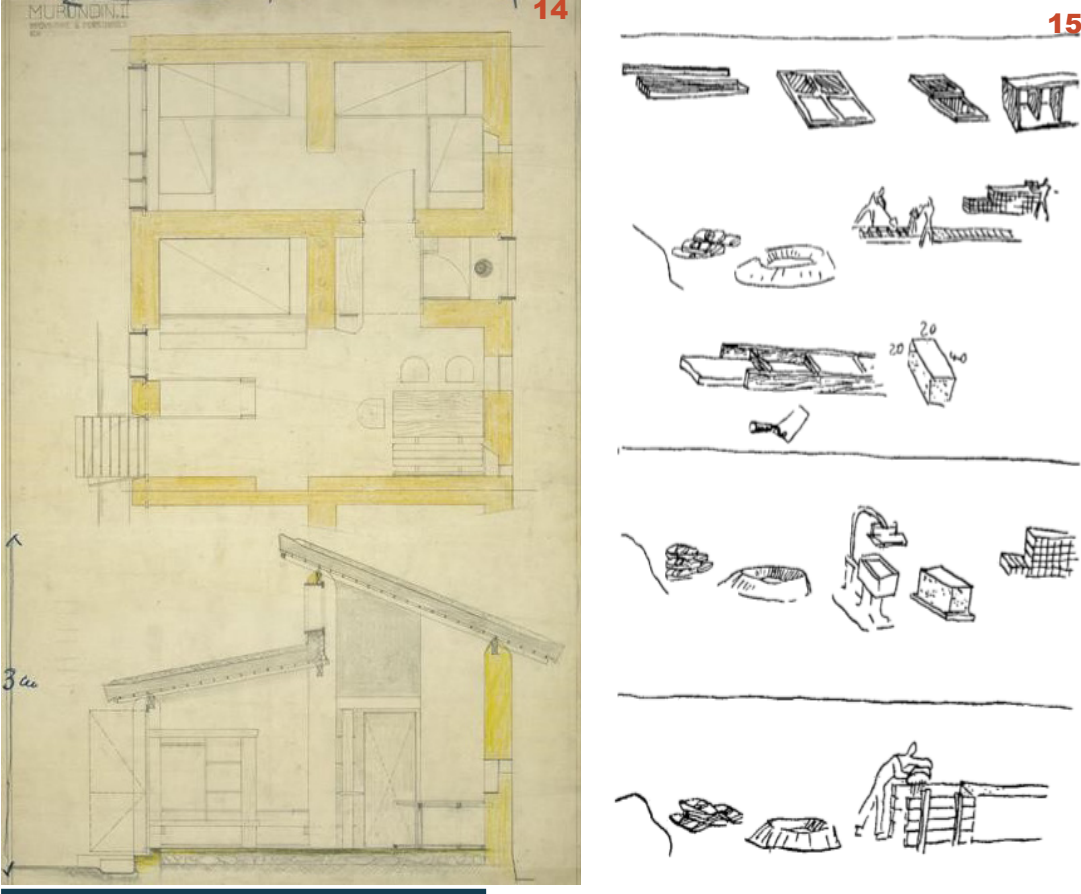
Projeto Les Maisons "Murondins", planta baixa e corte.
